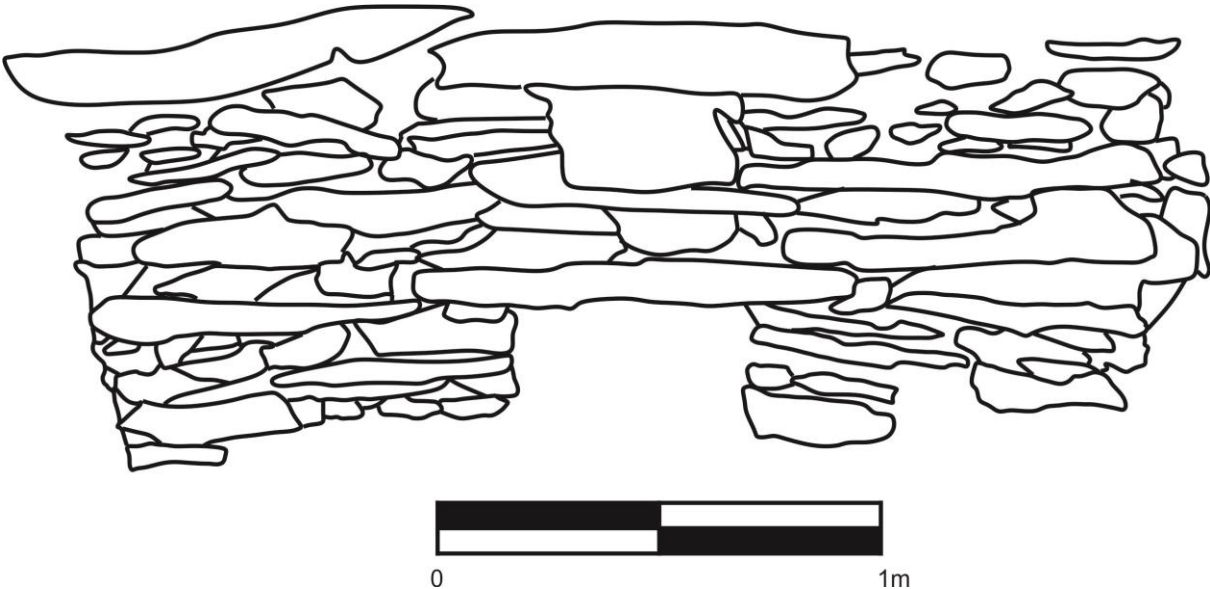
obsérvese el tipo de construcción en la fachada de la chullpa.
